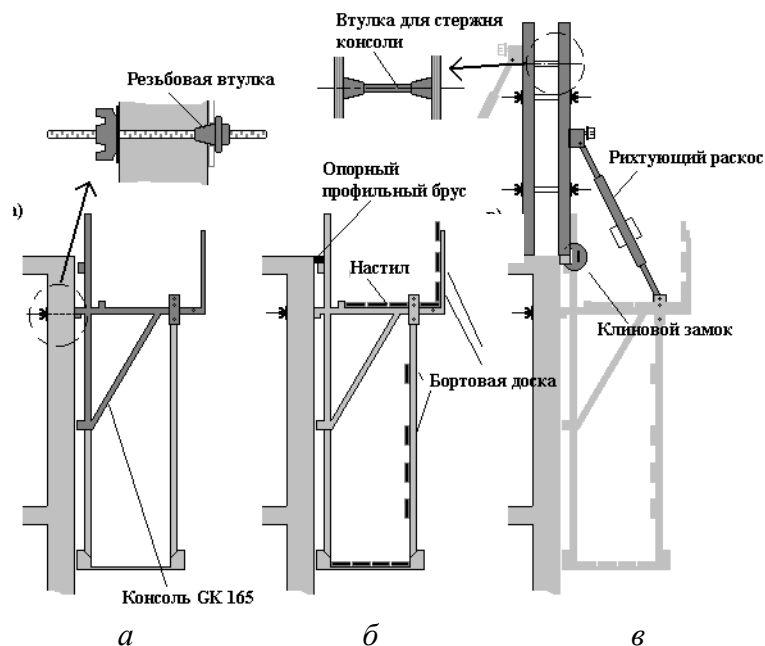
Пример крепления опалубки и обустройство рабочих мест по обрезу наружных стен: *а* – установка металлических навесных консолей; *б* – устройство настила и ограждения; *в* – установка щитов опалубки
